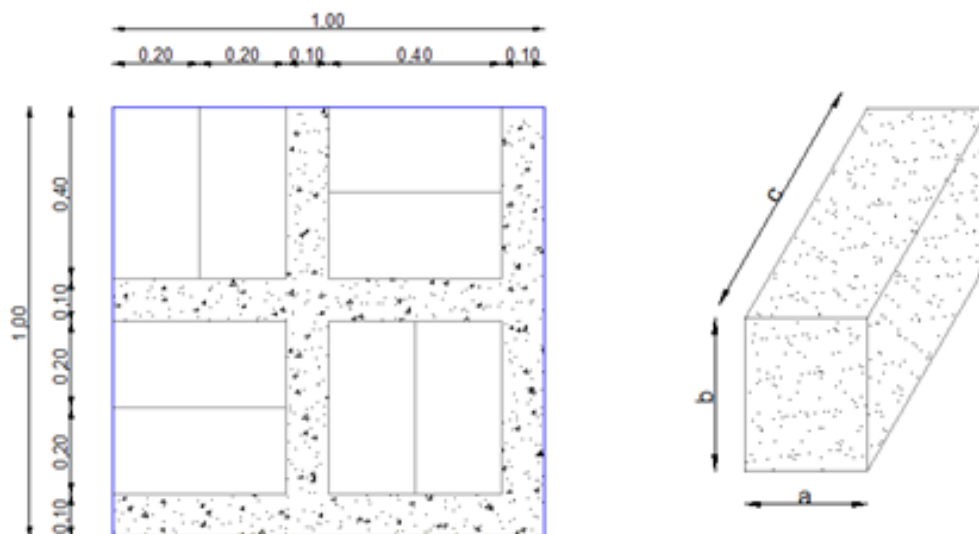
Detalle de losa alivianada a) Vista en planta; b) Detalle del bloque.
